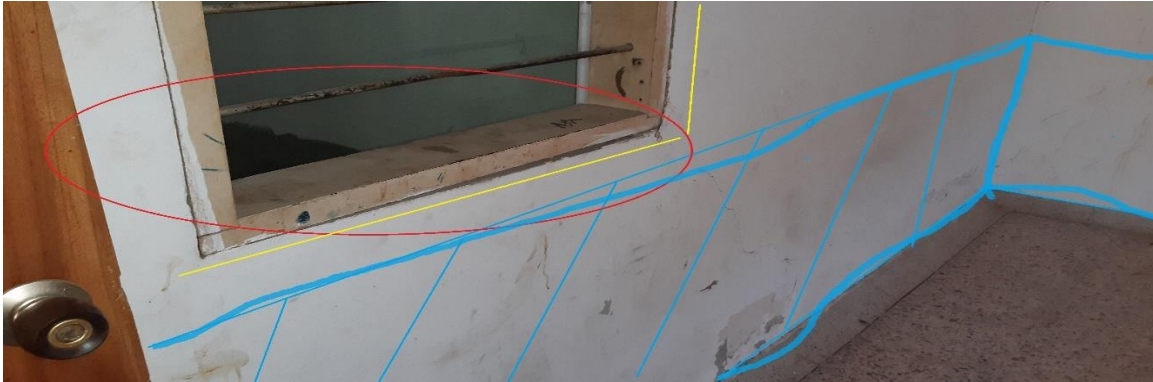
Marcos de ventanerías forzados debido a los movimientos y la inestabilidad de la estructura del inmueble, franja evidente de humedad, acompañada de fisuras y grietas en los muros.
